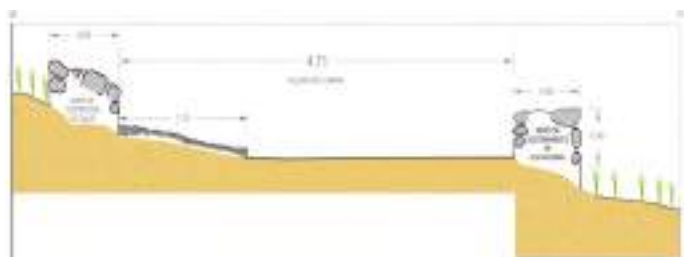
Corte transversal del camino, hallado en el sector de San José.
